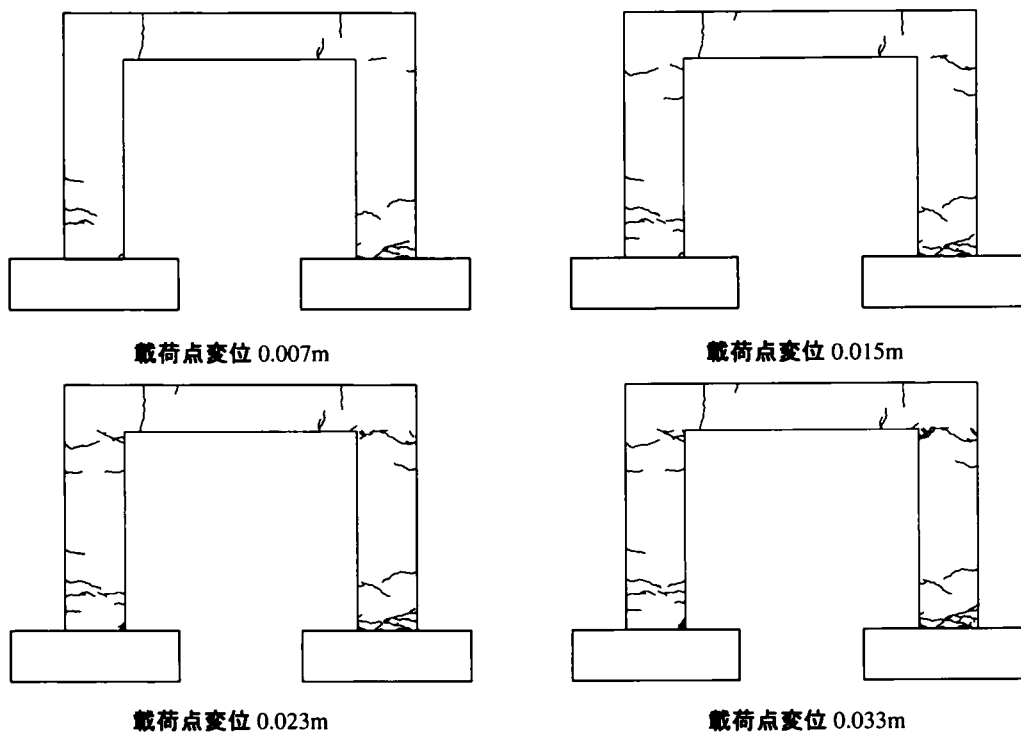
UBRC-3 供試体のひび割れの進展状況
